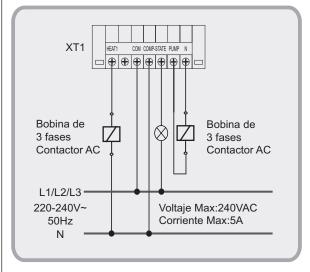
Cableado de la bomba de agua, del calentador auxiliar de las tuberías y de la luz de CA de estado del compresor
